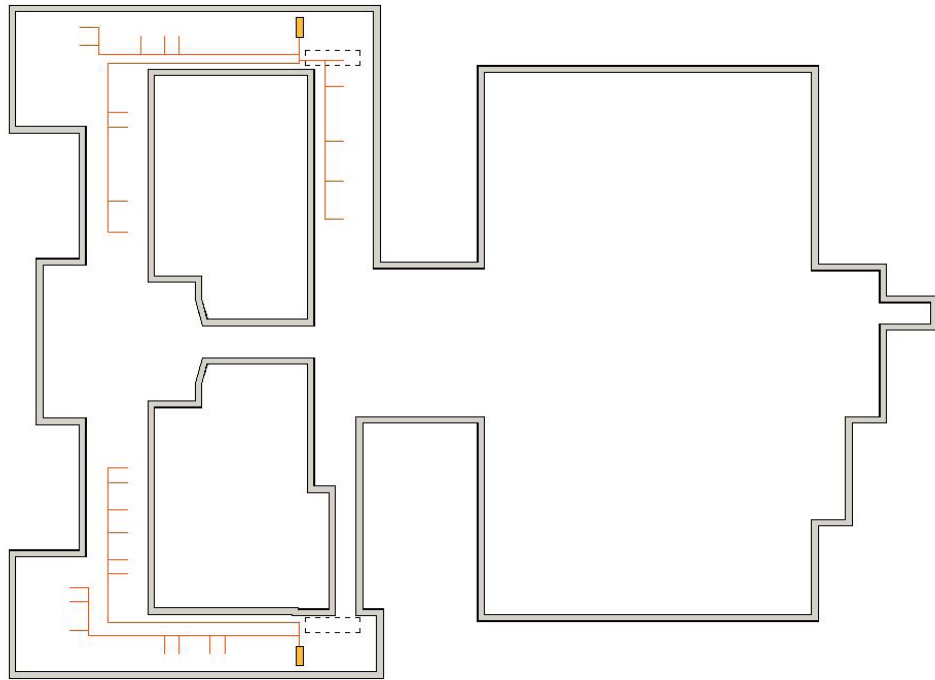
Individuazione cavedi collegamenti verticali.
